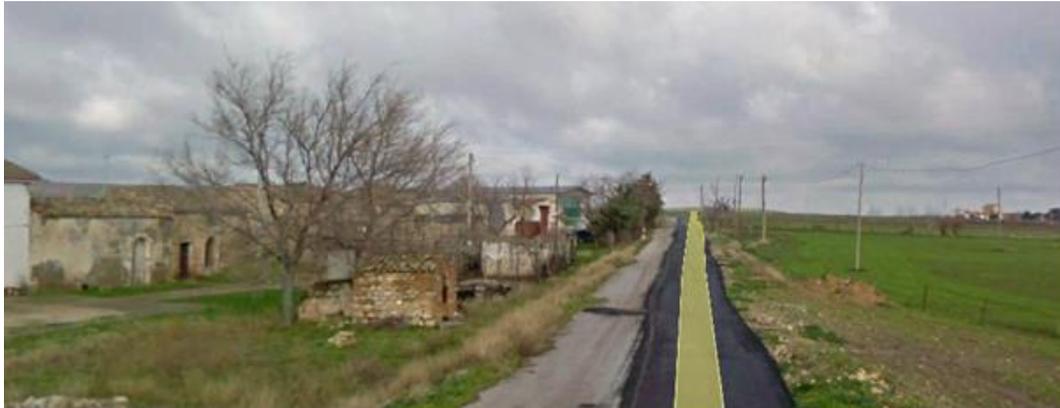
Attraversamento cavidotto esterno in area di rispetto “Masseria D’Amendola” – viabilità locale
